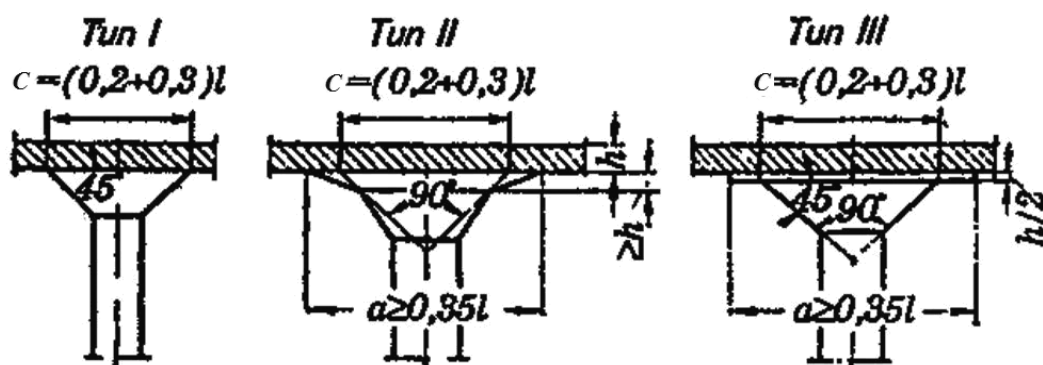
Типы капителей монолитных безбалочных перекрытий
